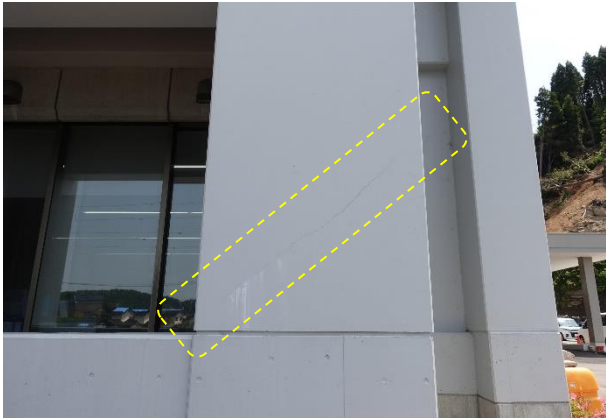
アウトフレーム柱のせん断ひび割れ
